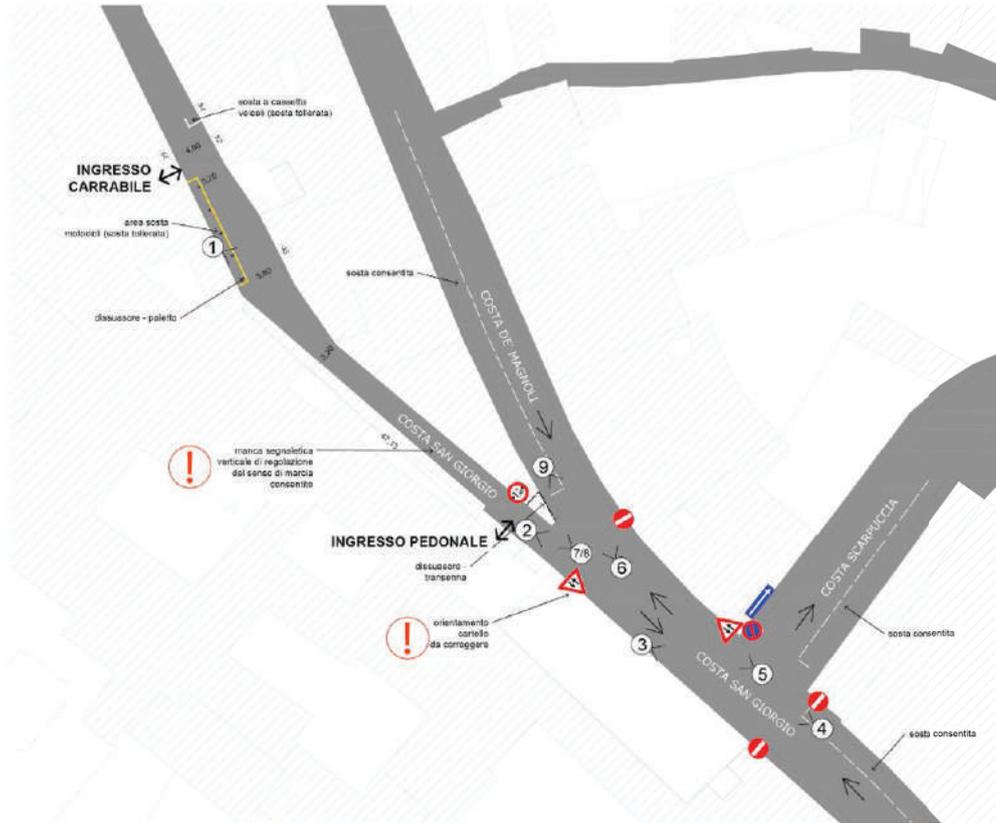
Planimetria dello Stato di fatto - Ingressi pedonale e carrabile
